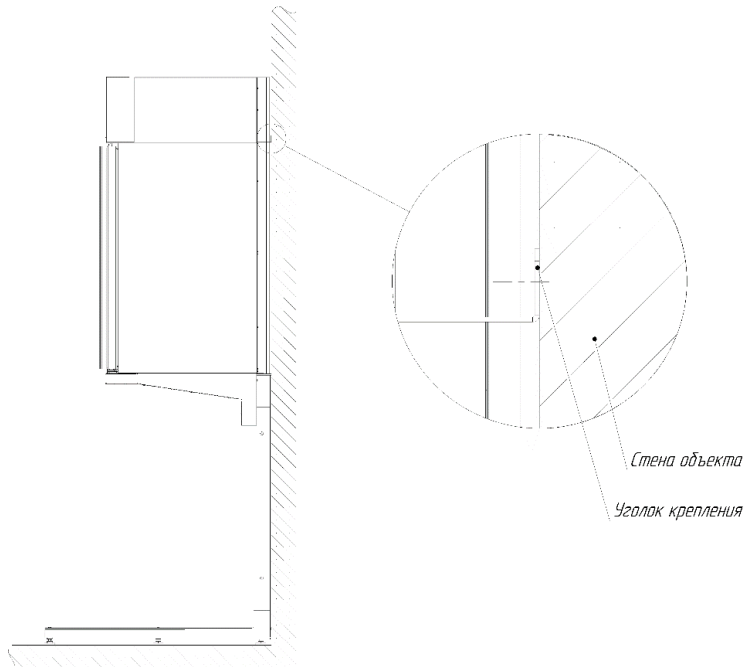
Сечение шкафа Крепление надстройки к бетонной стене
